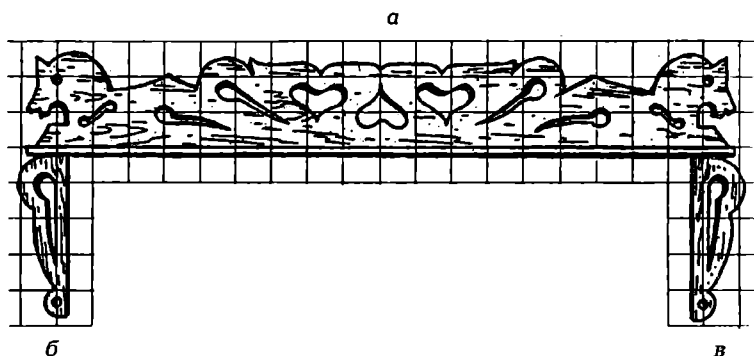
Пример подбора верхней резной доски наличника без короны со свесами:
